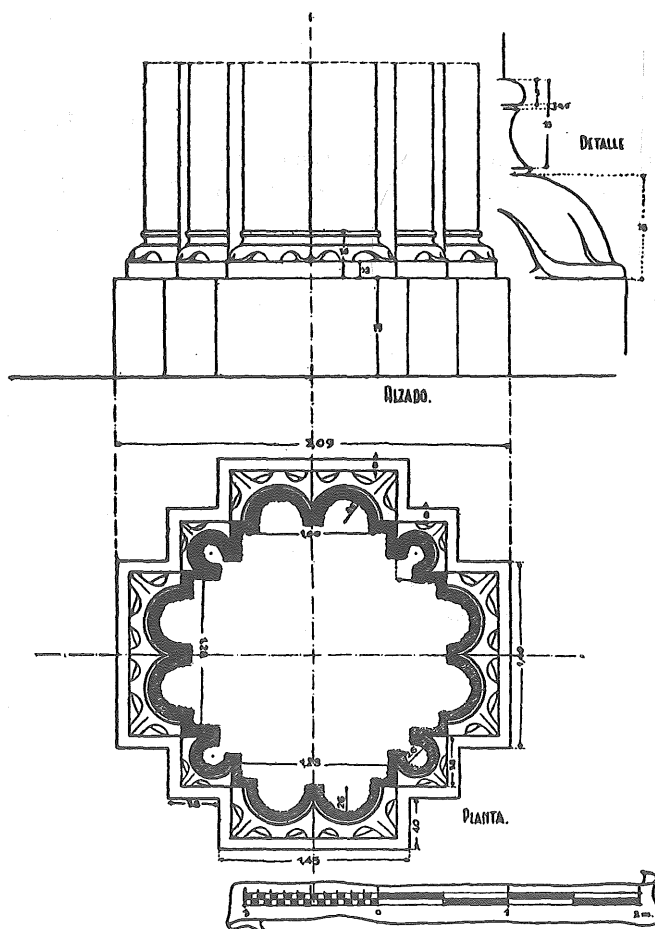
Sangüesa (Navarra). Plano de un pilar de Santa María la Real. (Dibujo de F. Sáenz Oiza.) Escala: 2 centímetros por metro.
